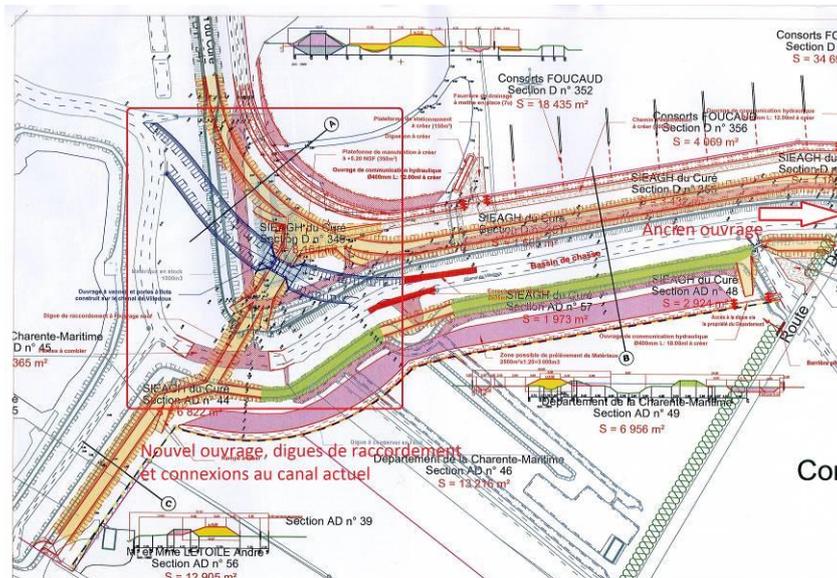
Plan du nouvel ouvrage du canal de Villedoux (source SIEAGH du Curé)
